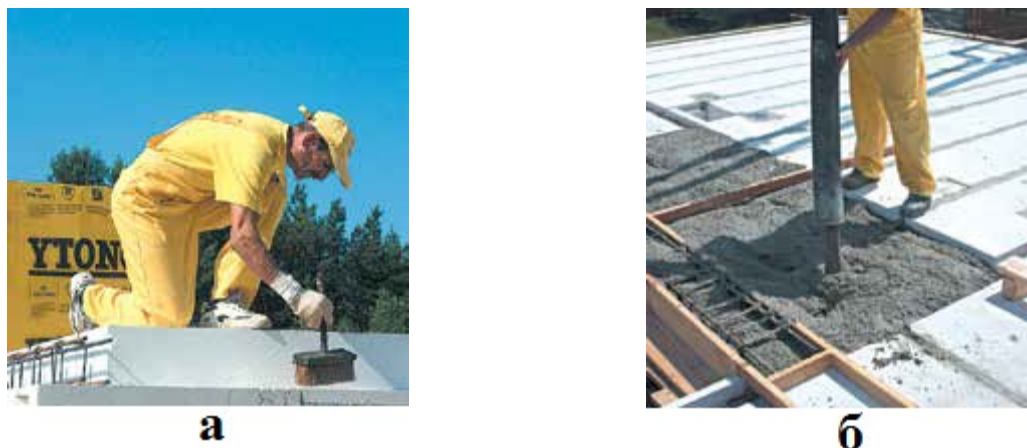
Контрольный осмотр (а) и бетонирование (б) перекрытия
